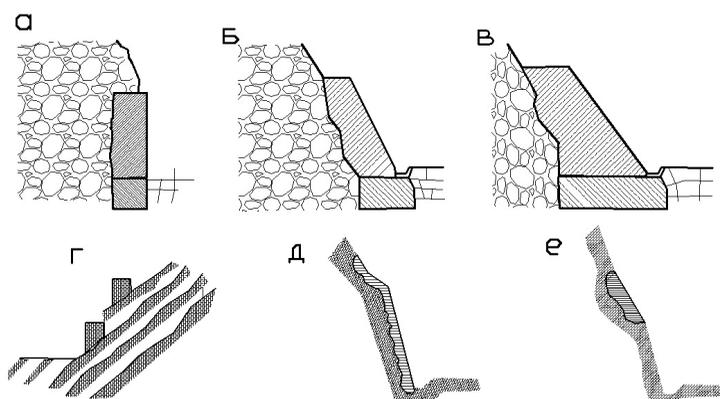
Монолитные удерживающие сооружения (СП 436.1325800.2018):
